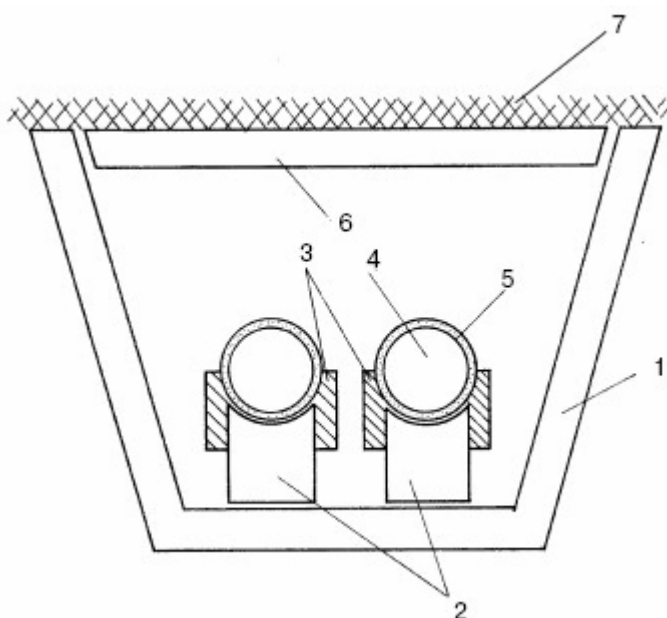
Укладка отопительных трубопроводов в лотки: 1 – лоток; 2 – опоры под трубы; 3 – крепление труб; 4 – труба; 5 – изоляция; 6 – плита перекрытия; 7 – грунт
